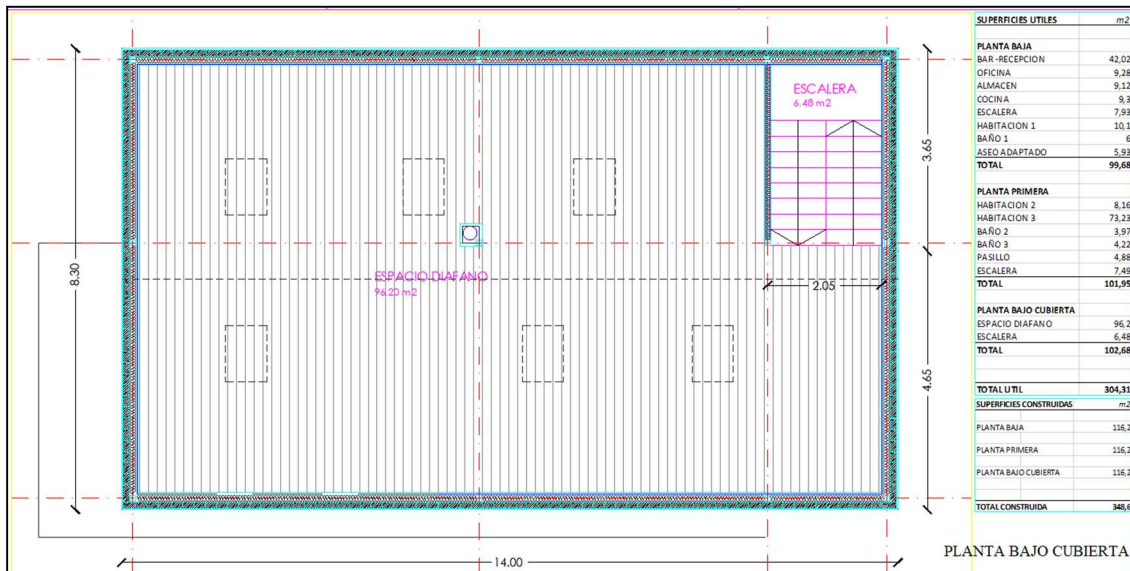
Plano de la planta segunda (bajo cubierta). (Fuente: Proyecto básico y en ejecución Albergue en Sabayés, Nuero (Huesca) (Gavin, 2017))
